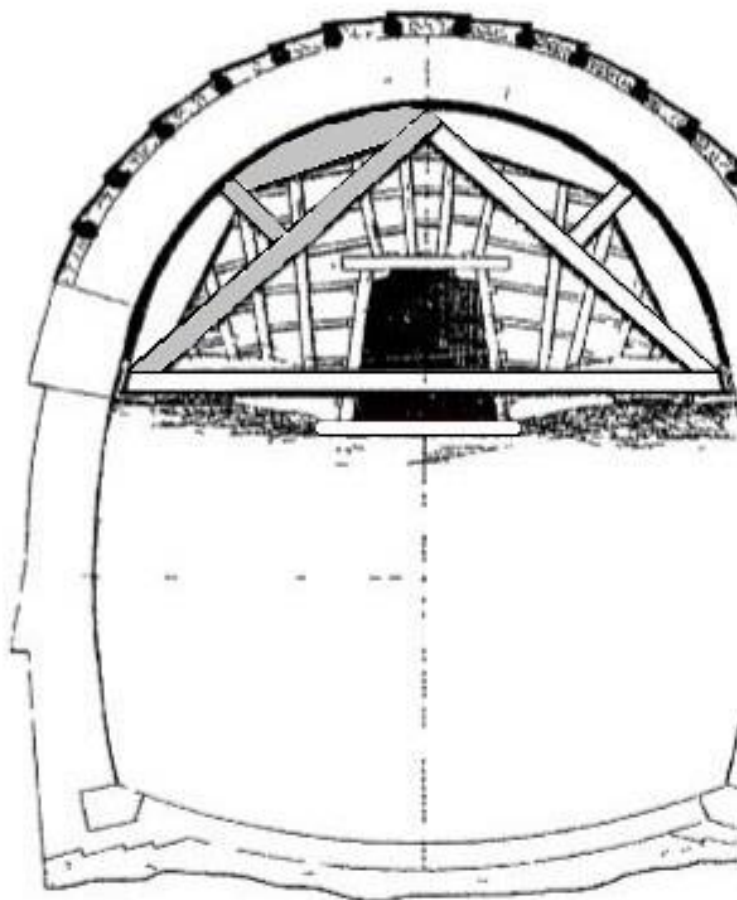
Tekening van de houtconstructie tijdens de bouw van de Northchurch Tunnel op 17 juni 1837 (John Cooke Bourne, 1837).
